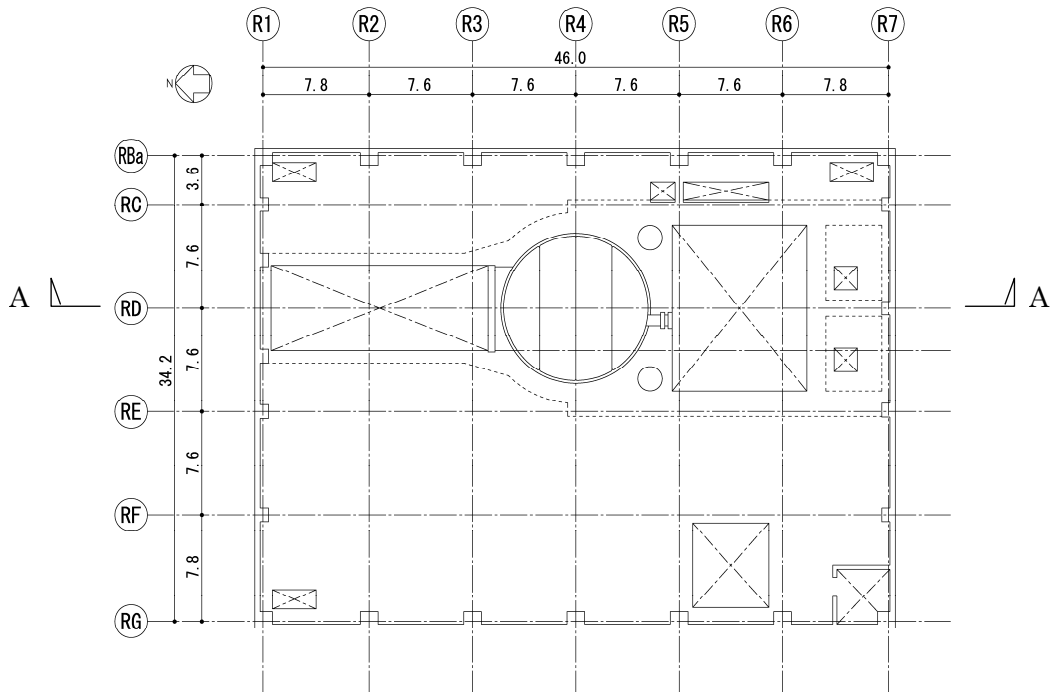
5階 (OP 39.92) 平面図 (单位 : m)
